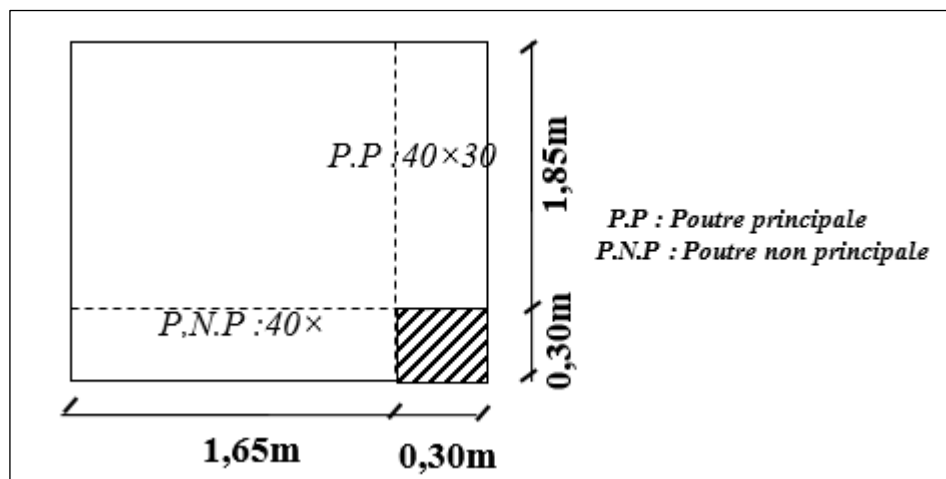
Surface revenant au poteau d'angle le plus sollicité.
